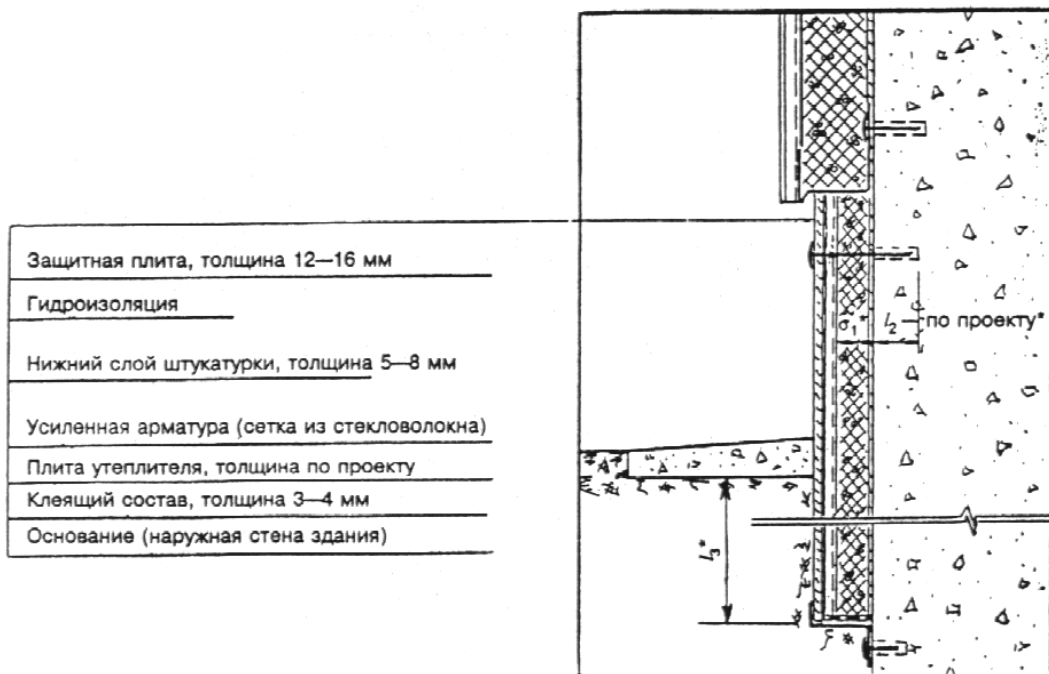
Фрагмент утепления нижней (и ее заглубленной) части стены здания
